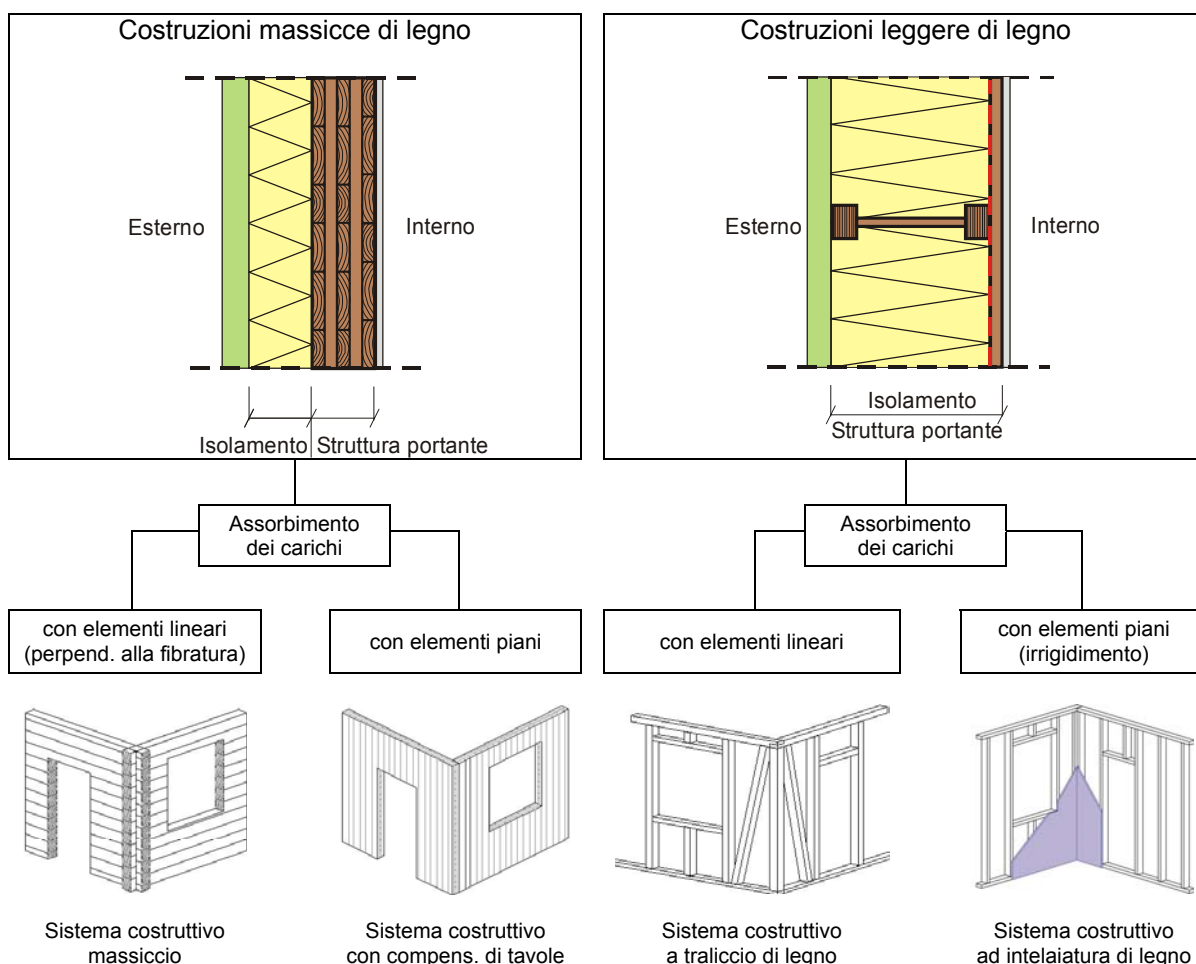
Suddivisione di base dei sistemi costruttivi di legno (sezione orizzontale ed assonometria)
